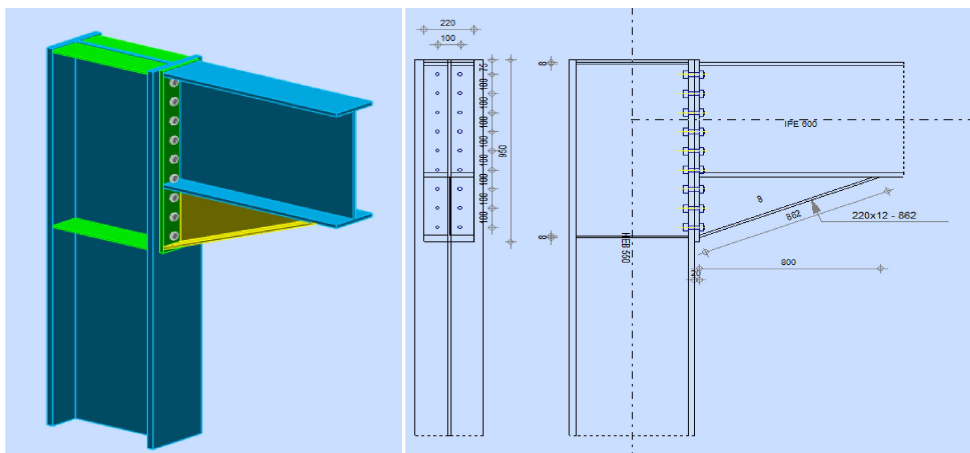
Assemblage poteauHEB550 – poutreIPE600
